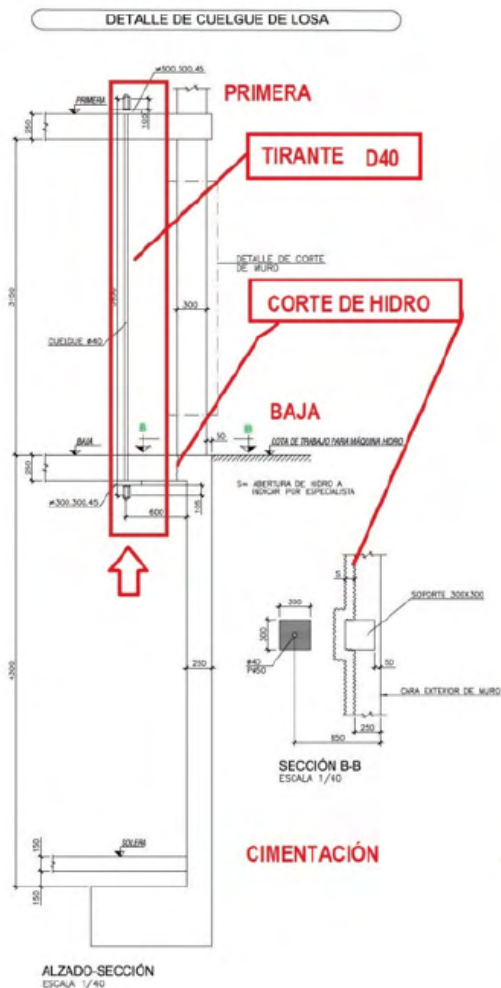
Esquema de tirantes de cuelgue en losa de baja cortada en muro. Apeo metálico en soporte sobre muro.
